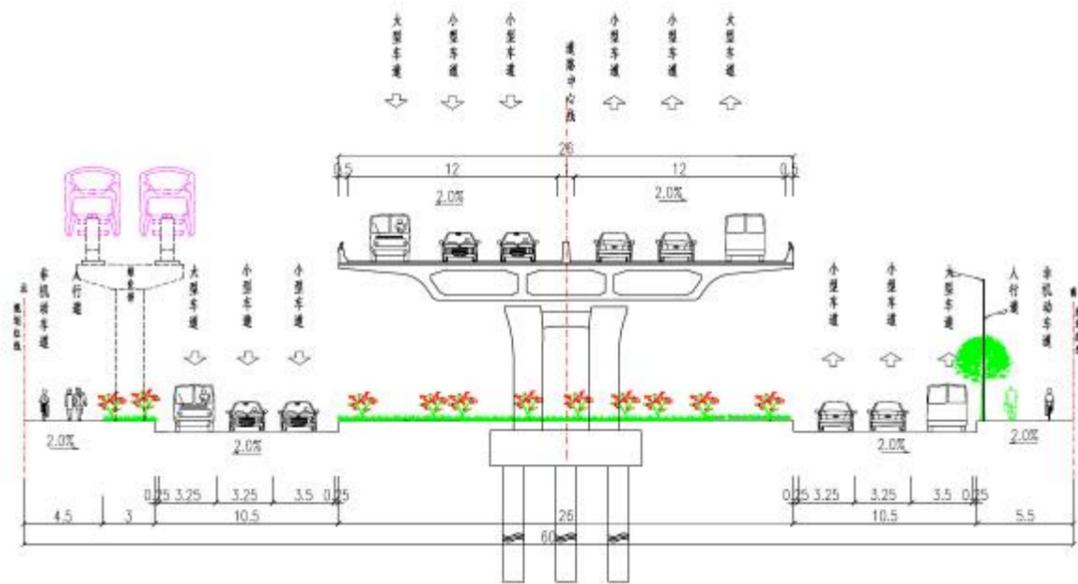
潮汕路-护堤路段横断面图（尺寸单位：m）
